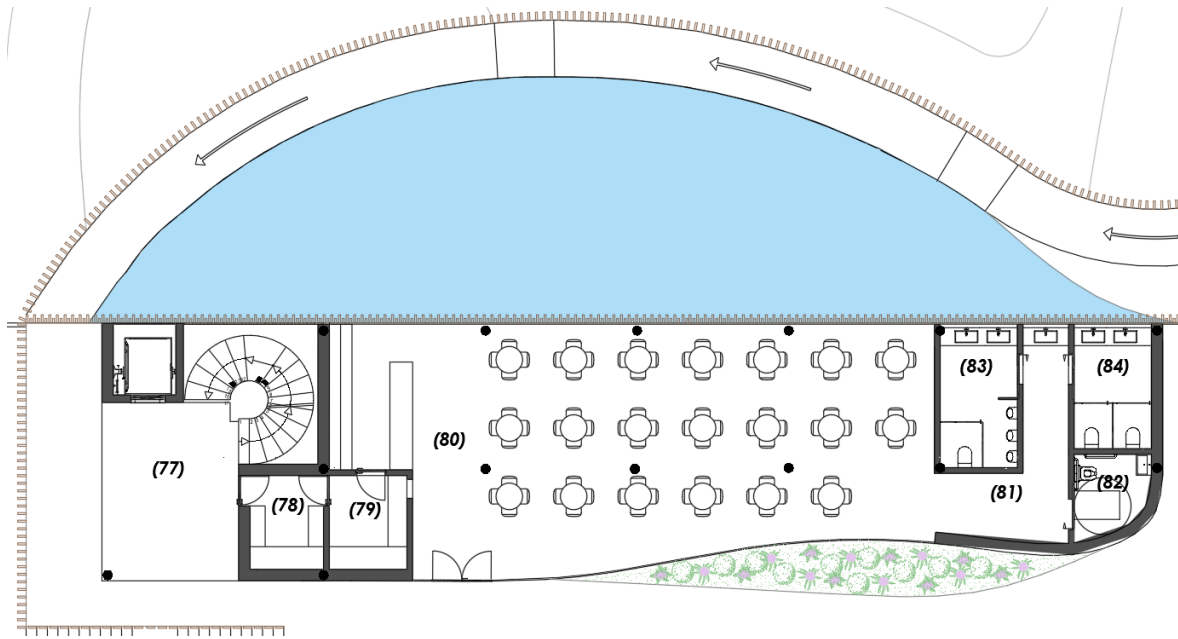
PLANTA DO CAFÉ (PISO 2)
